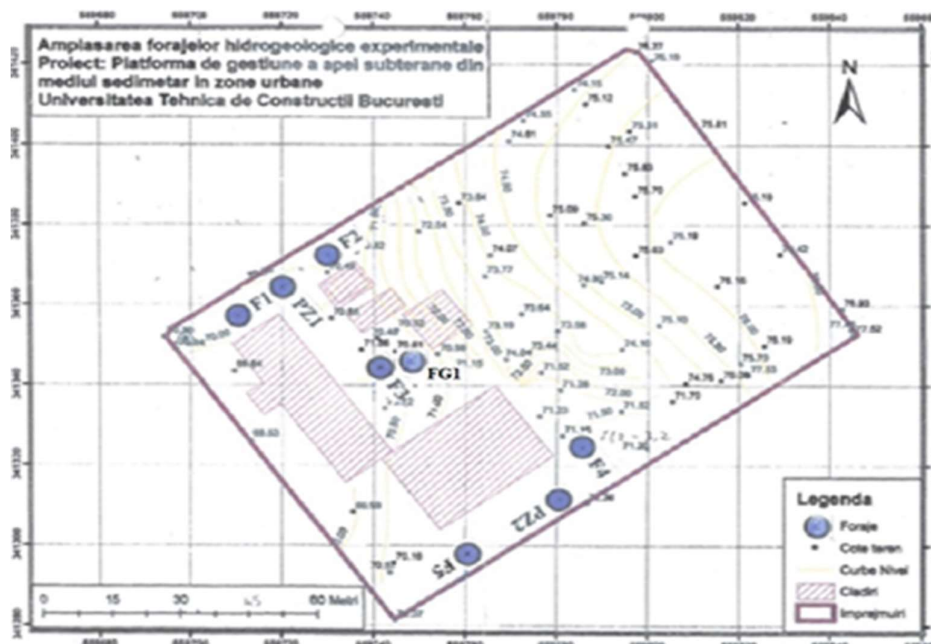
Plan cu poziționarea forajelor de studiu, site Colentina
